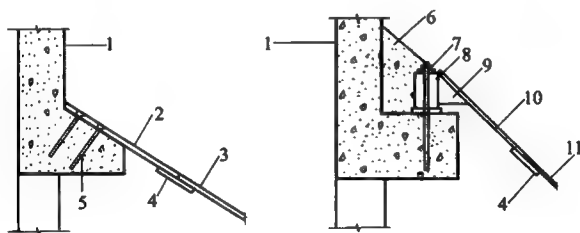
钢漏斗与混凝土仓壁的连接示意图
